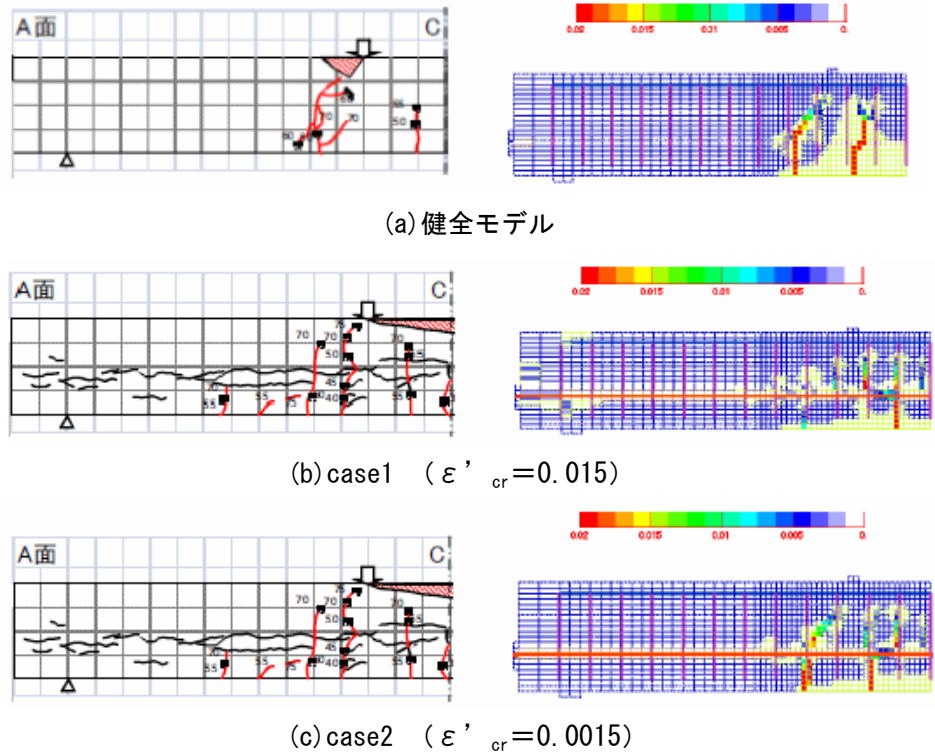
曲げひび割れ発生状況 (左：実験，右：解析)
